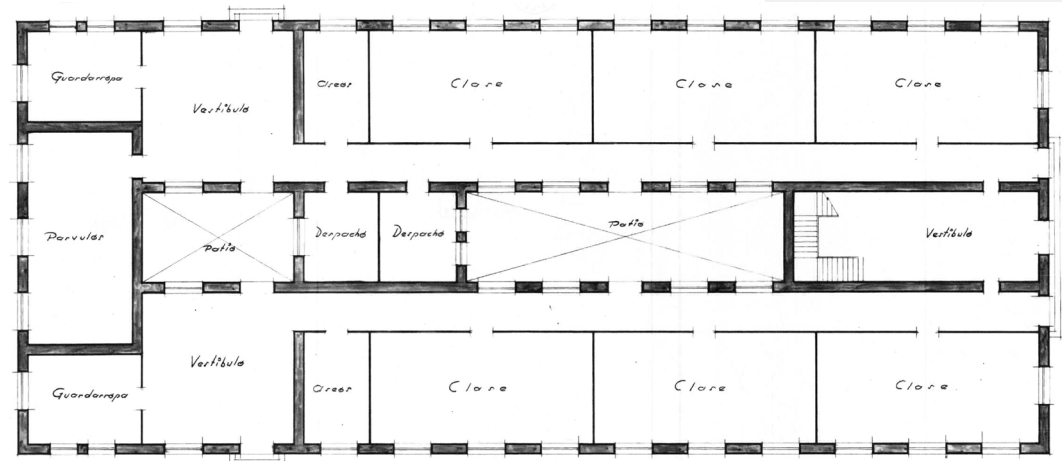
, Planta Baja Grupo Escolar. Intervención 1951, Antonio Serrano
